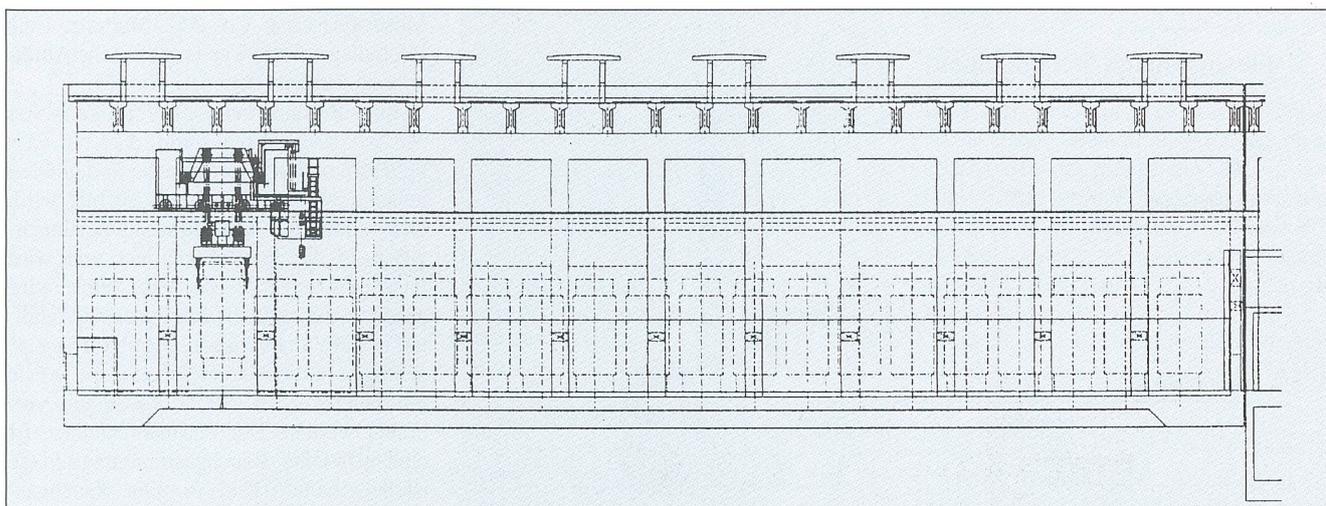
Schnitt durch Lagerhalle für Transport- und Lagerbehälter
